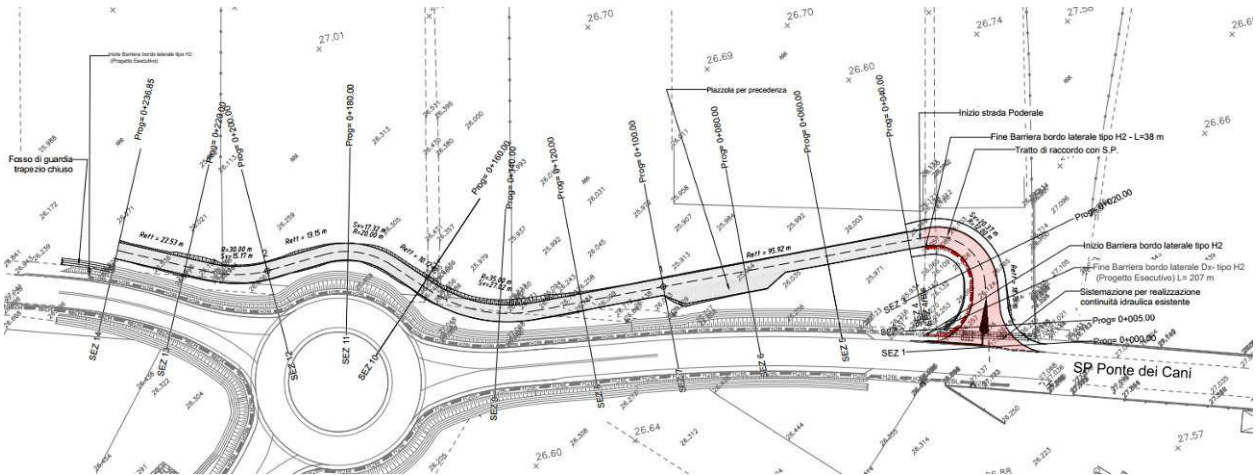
Stralcio planimetrico nuova viabilità agricola
